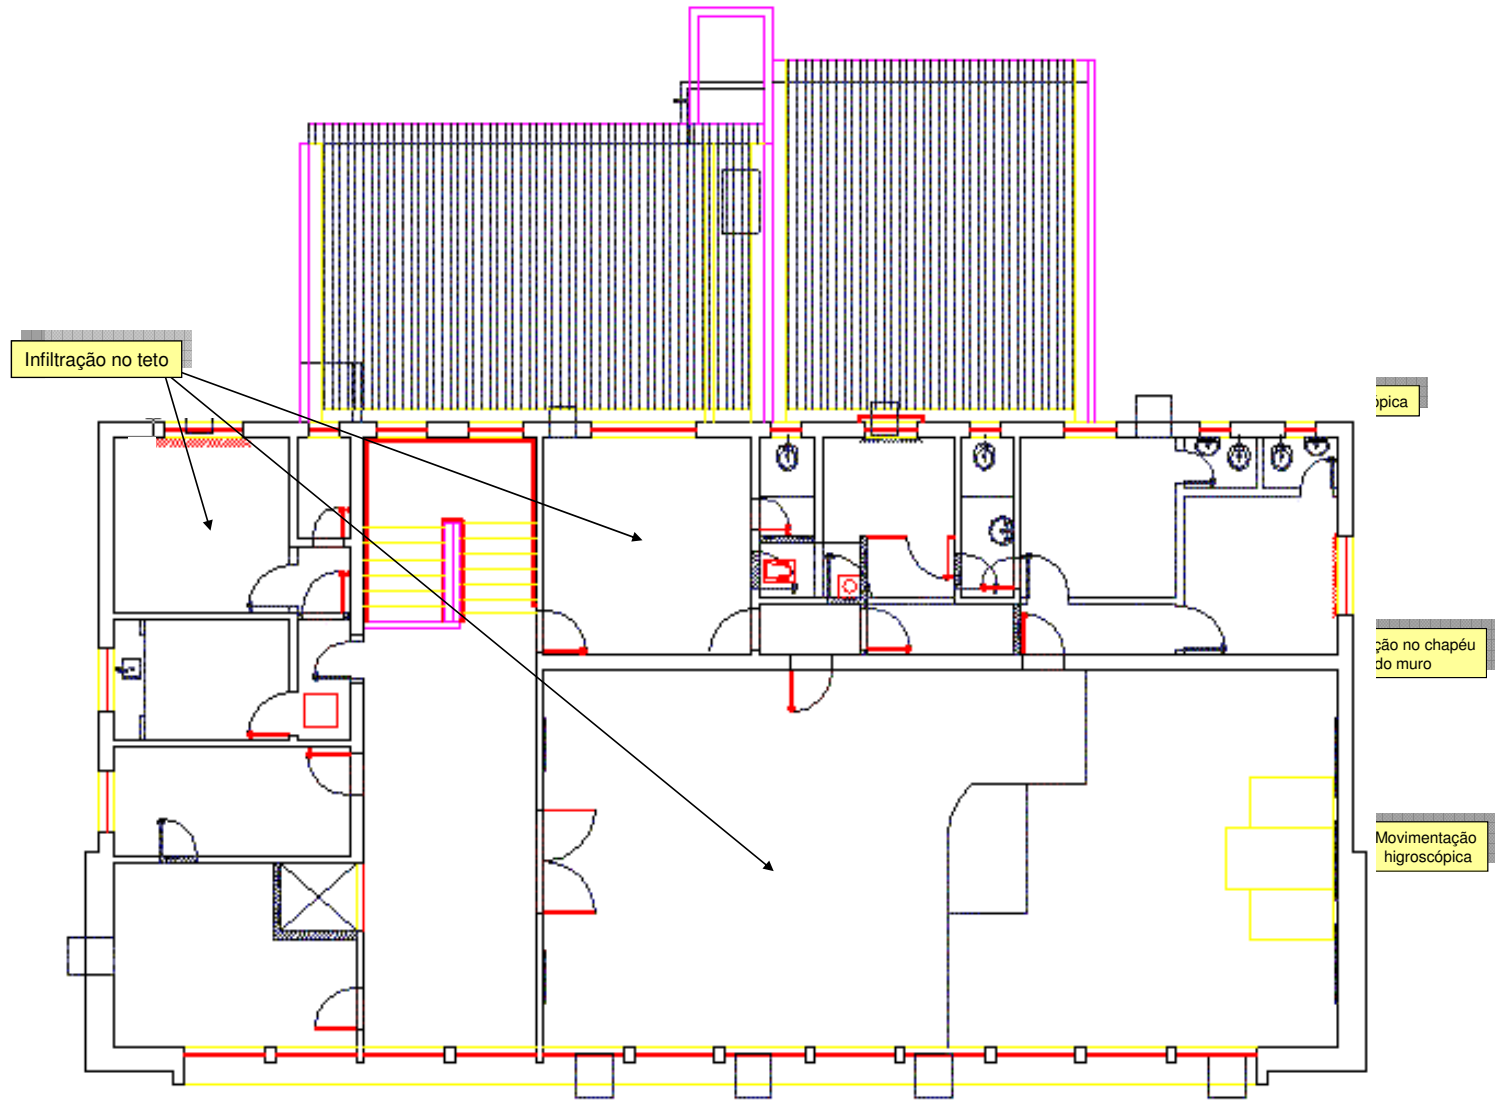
Planta do 2º pavimento e suas patologias.
